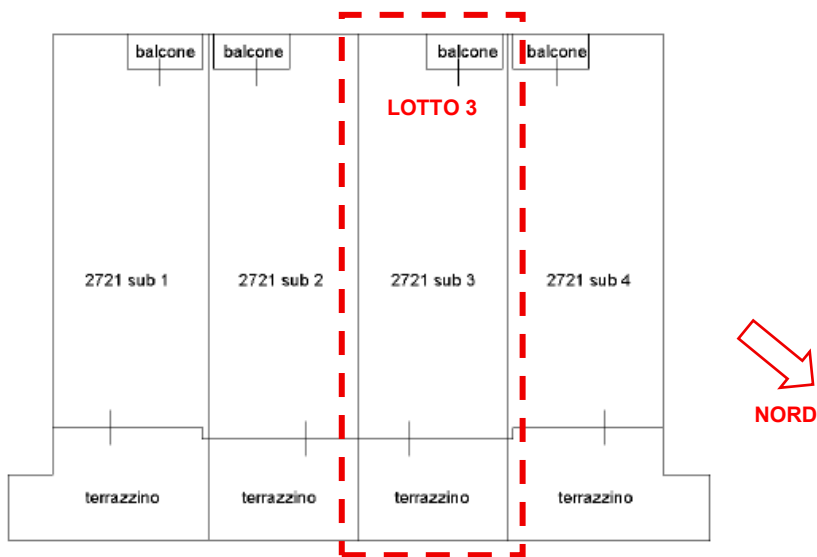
Stralcio dell'elaborato planimetrico (Piano 1, fuori scala)
